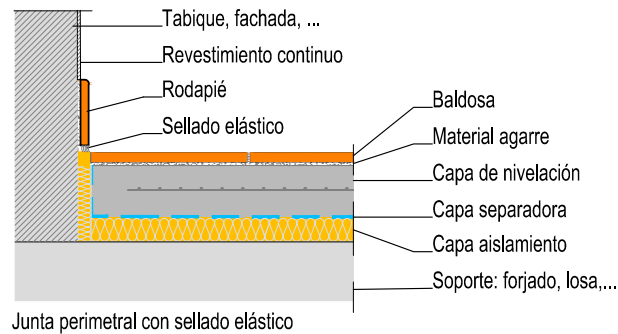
Detalle válido para tabiquería que apoya en el forjado.
